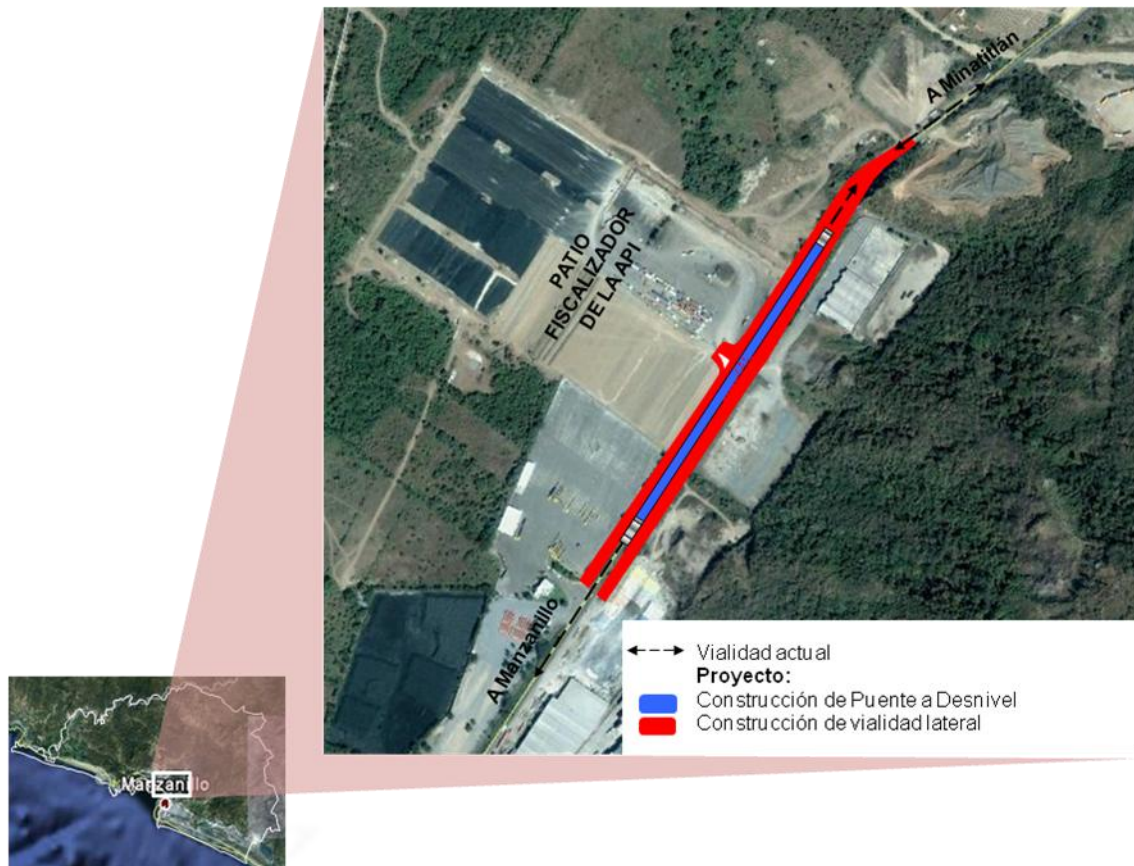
Esquema general de la propuesta constructiva del proyecto
